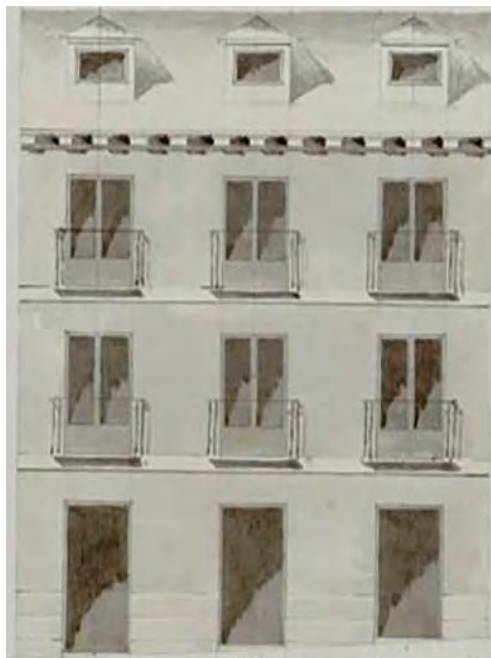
Alzado de casa construida en c/ del Salitre (1832-AVM:1-63-121).
